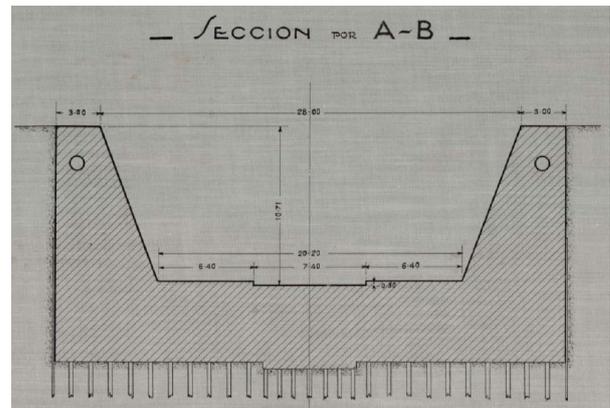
Sección transversal en la que pueden apreciarse los muros cajeros, la solera de fondo y la cimentación sobre pilotes de madera
